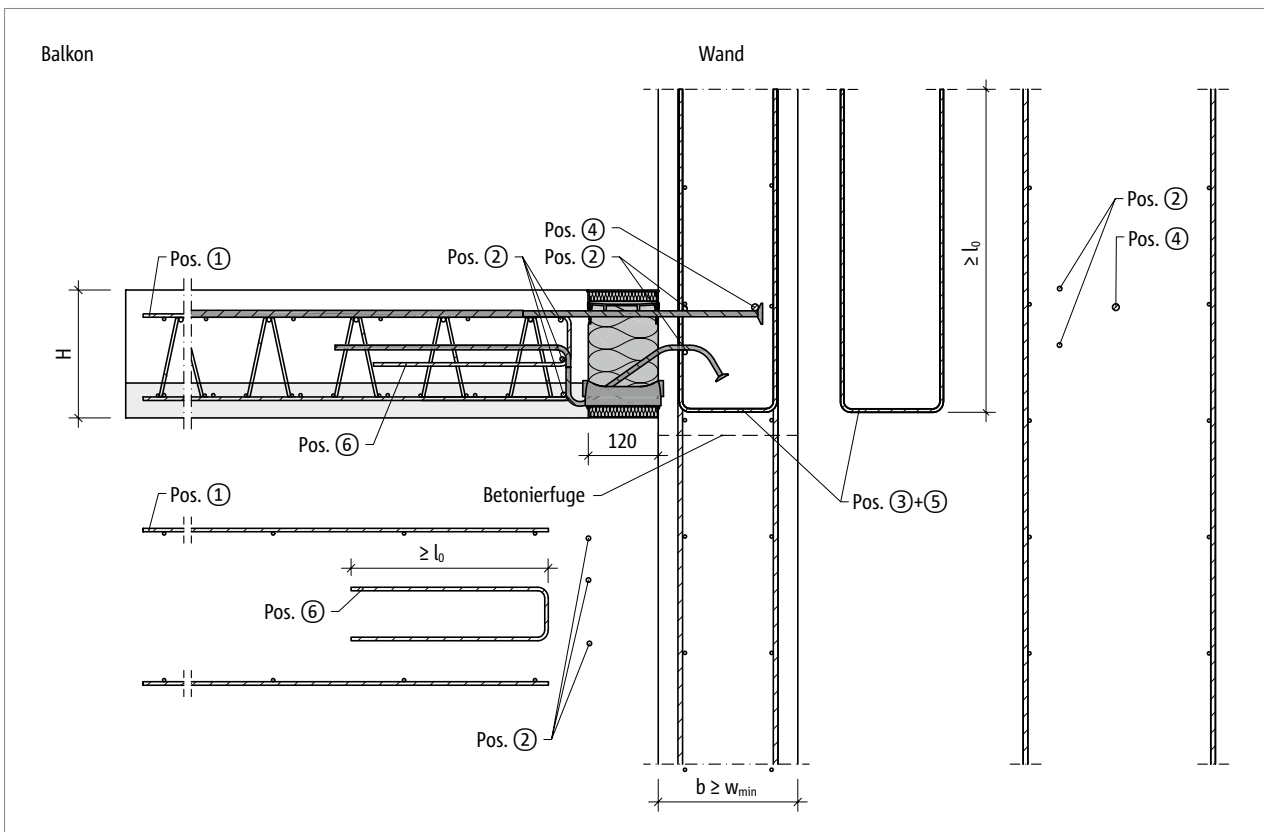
Schöck Isokorb® XT Typ KL-U-F: Bauseitige Bewehrung für Wandanschluss nach oben
